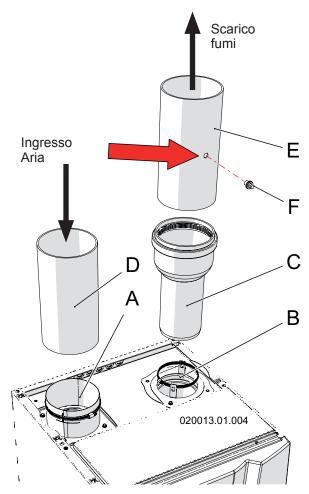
Installazione del sistema "Sdoppiato 80/80"
